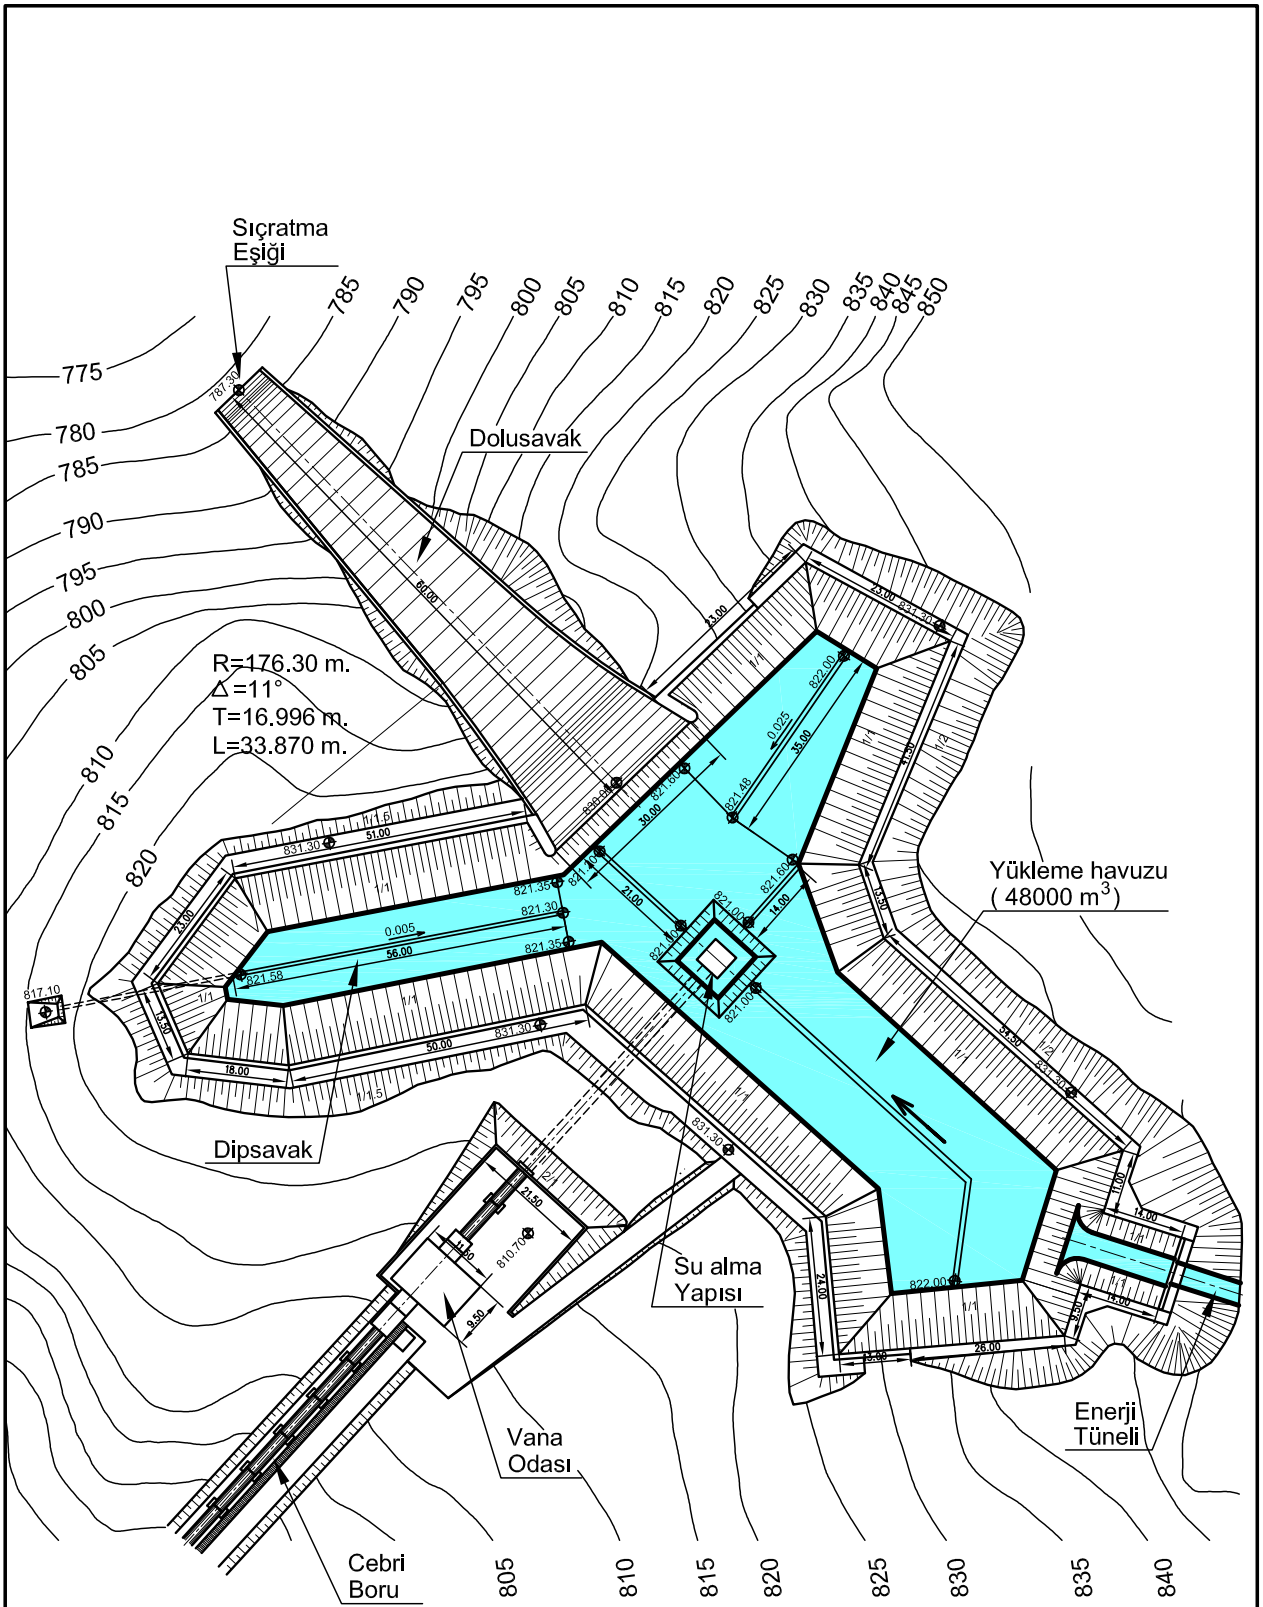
Leaburg HES (A.B.D.) Yükleme Havuzu Planı (Kaynak 4)
